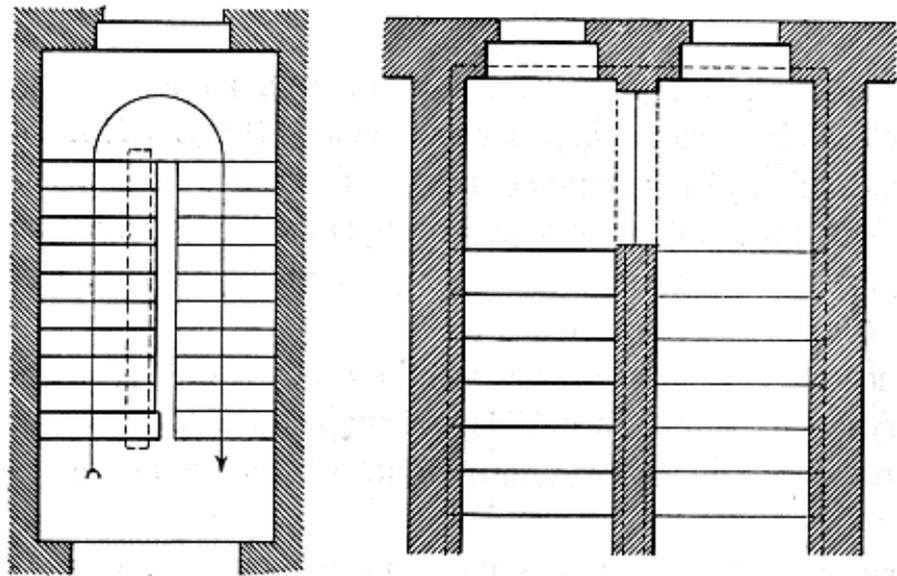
План лестниц с опорой на двух стенах. В.Р. Бернгард, 1903 г. [7]
